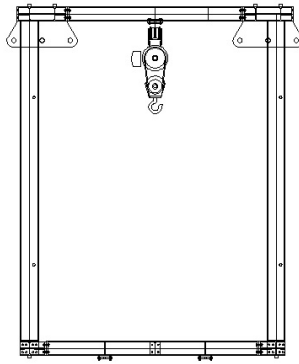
Secção transversal da viga principal do cimbre [21].
